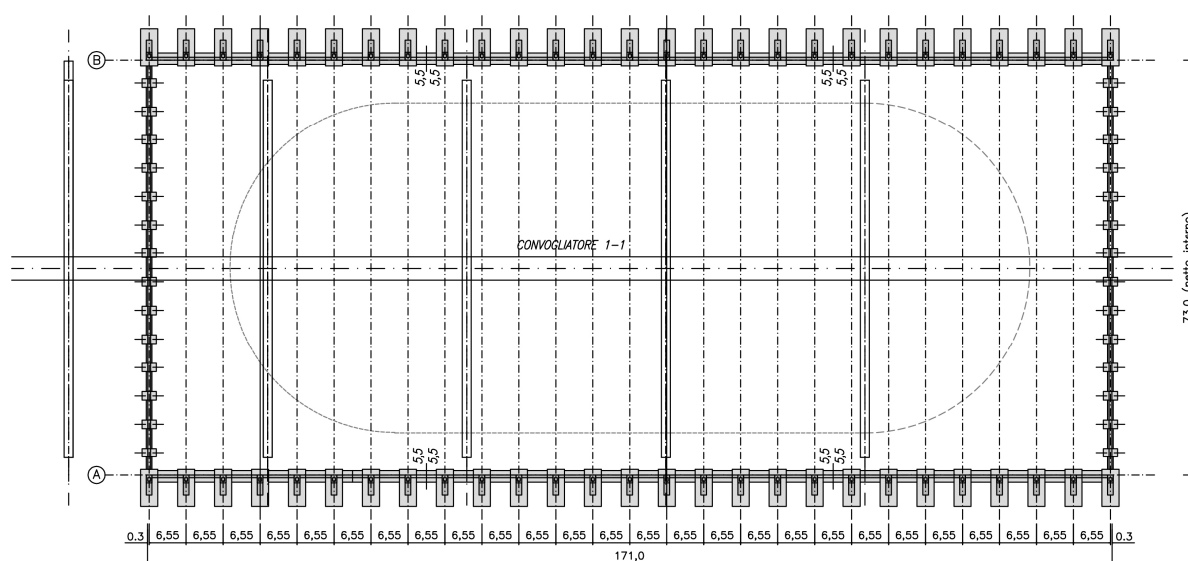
a Vista in pianta della copertura proposta
